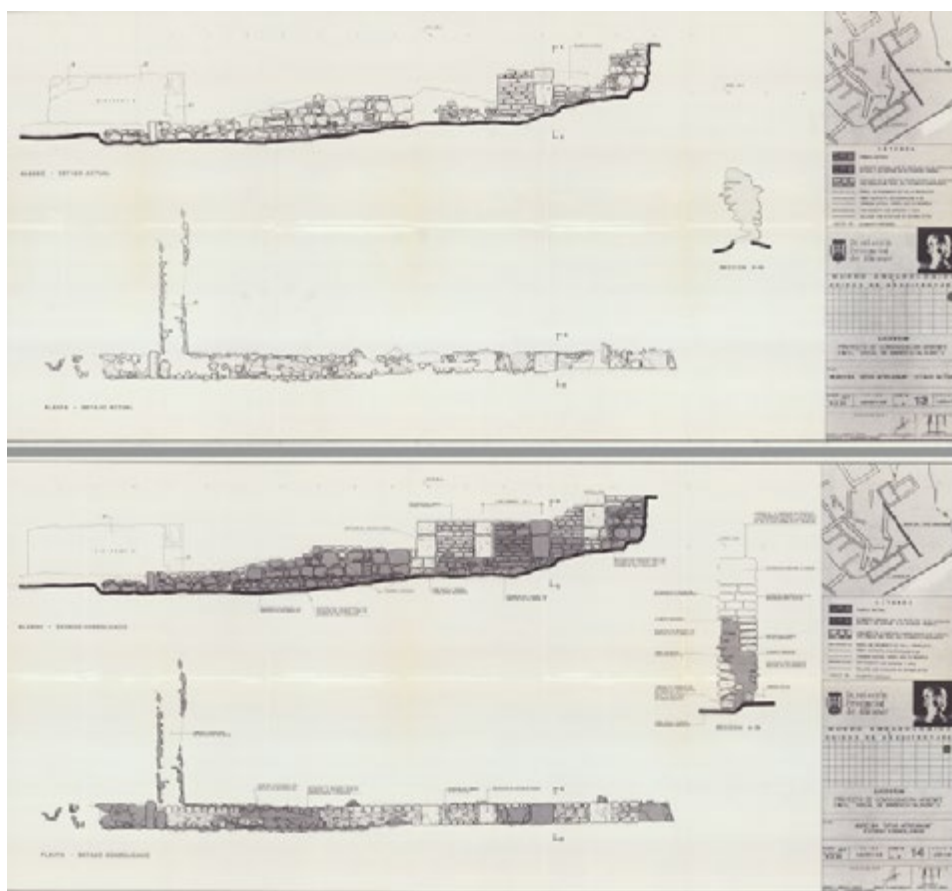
Proyecto de Consolidación Urgente. Propuesta de recuperación del muro de opus africanum. Sobre su descubrimiento, en las excavaciones de J. Lafuente Vidal. vid. V.4.1. ATM.
